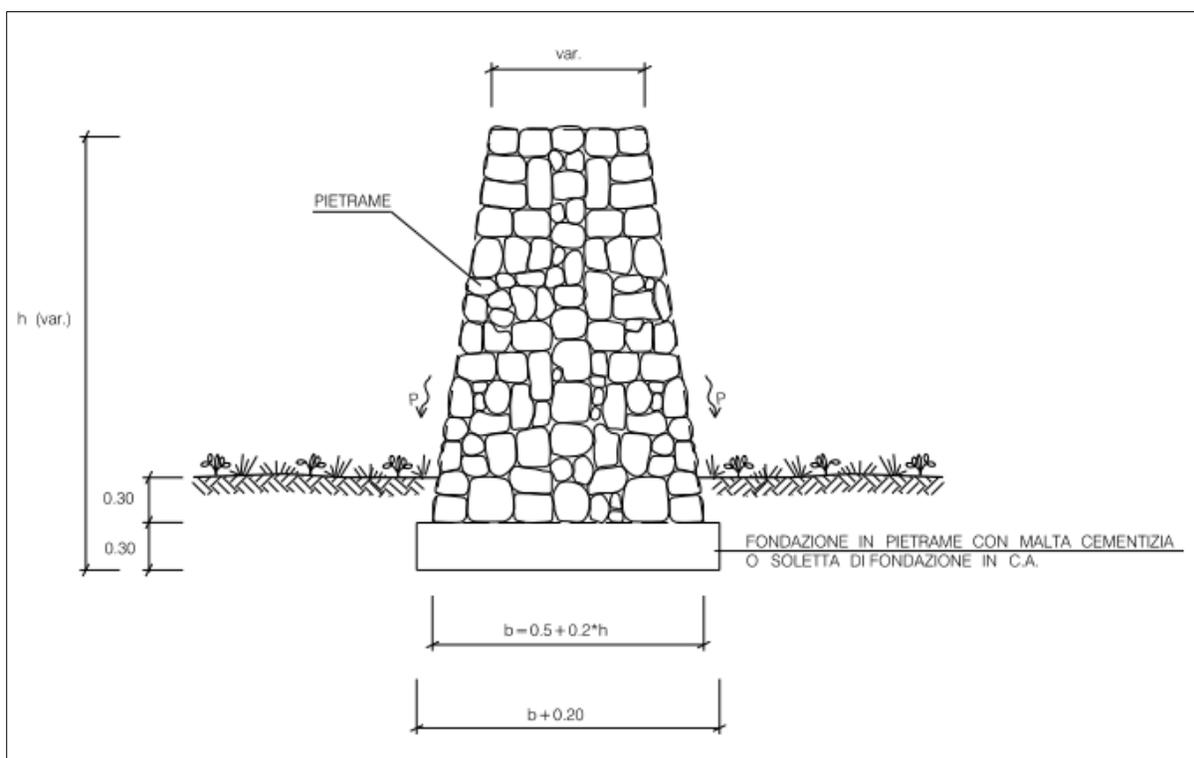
schema muro in pietrame con funzione di confinamento
